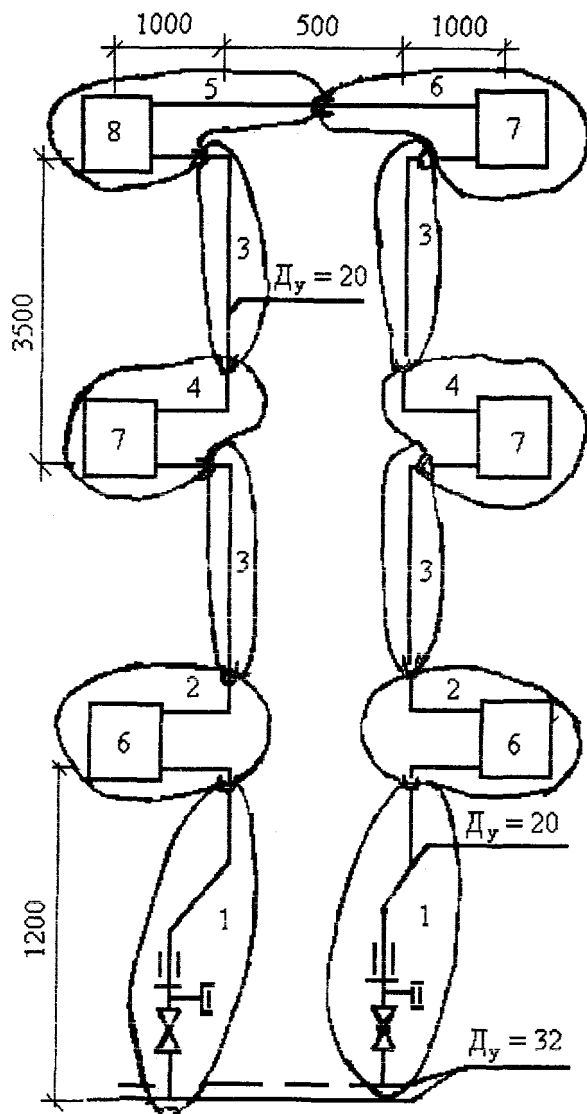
Схема стояка системы отопления с разбивкой на узлы
